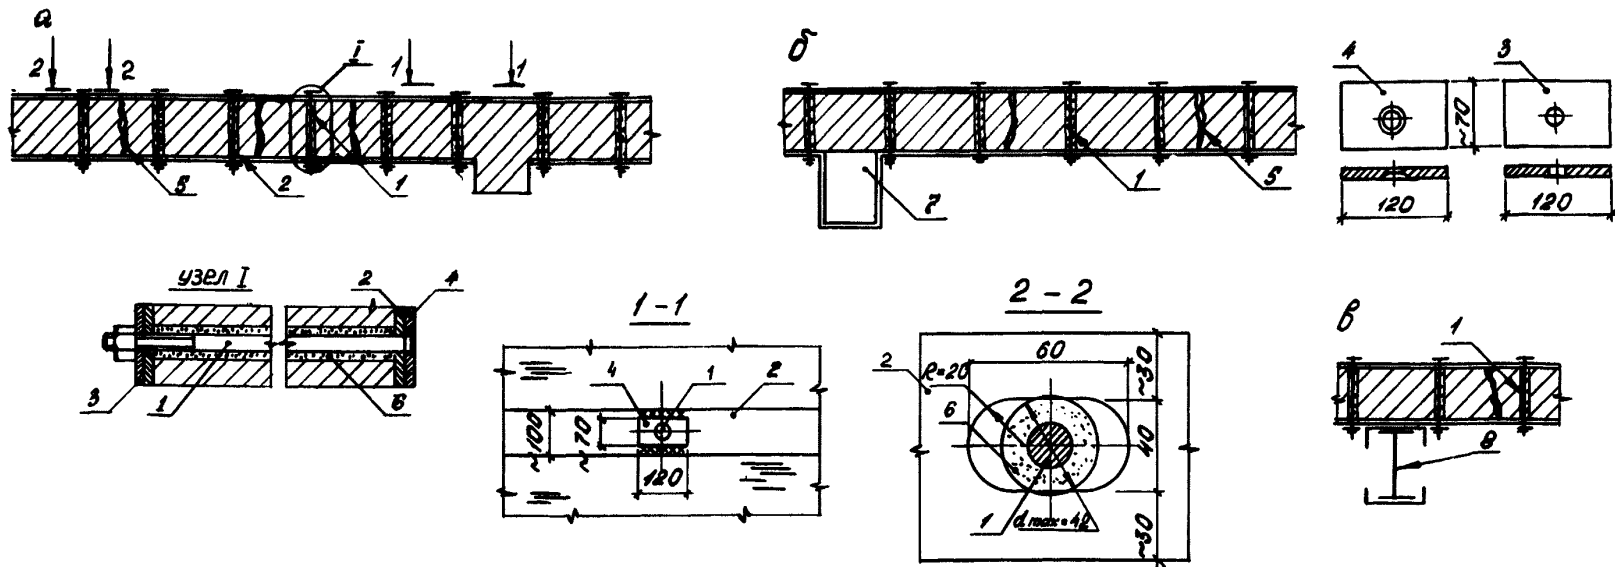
Схемы усиления каменной кладки с трещинами:
